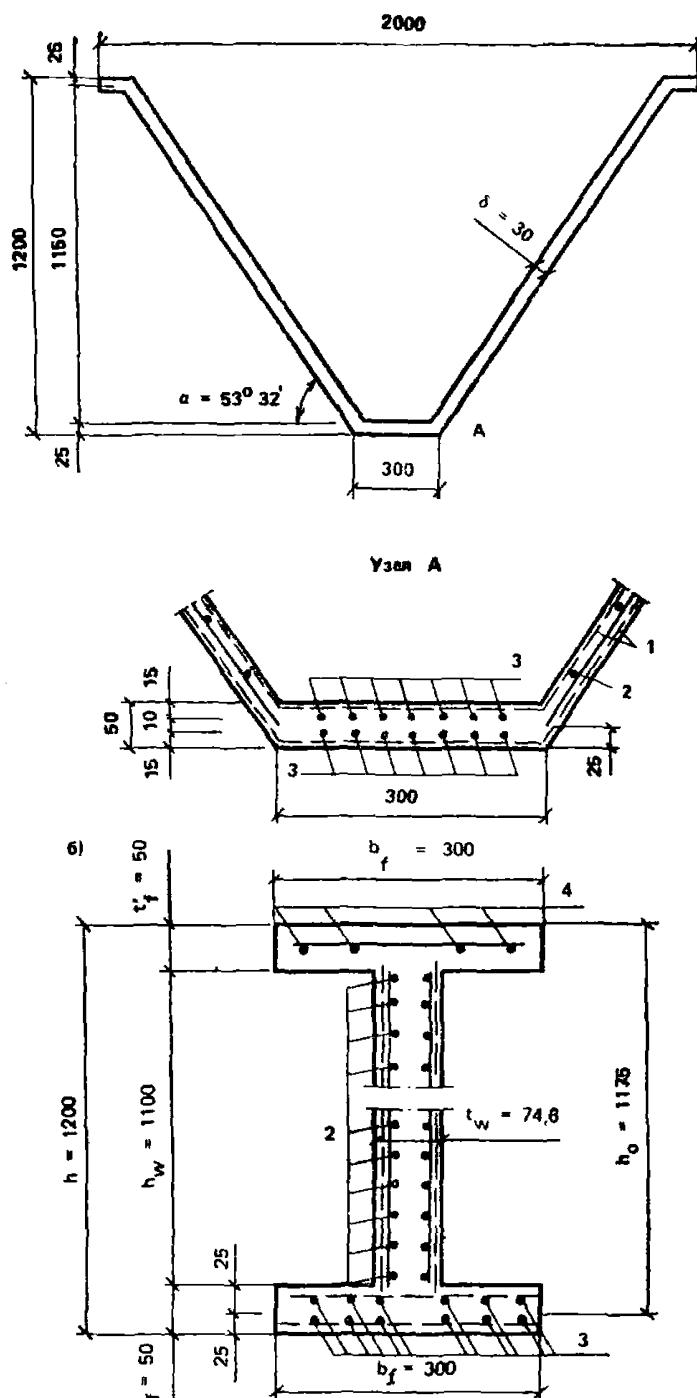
Сечения армоцементной складки покрытия пролетом 18 м с предварительно напряженной арматурой
